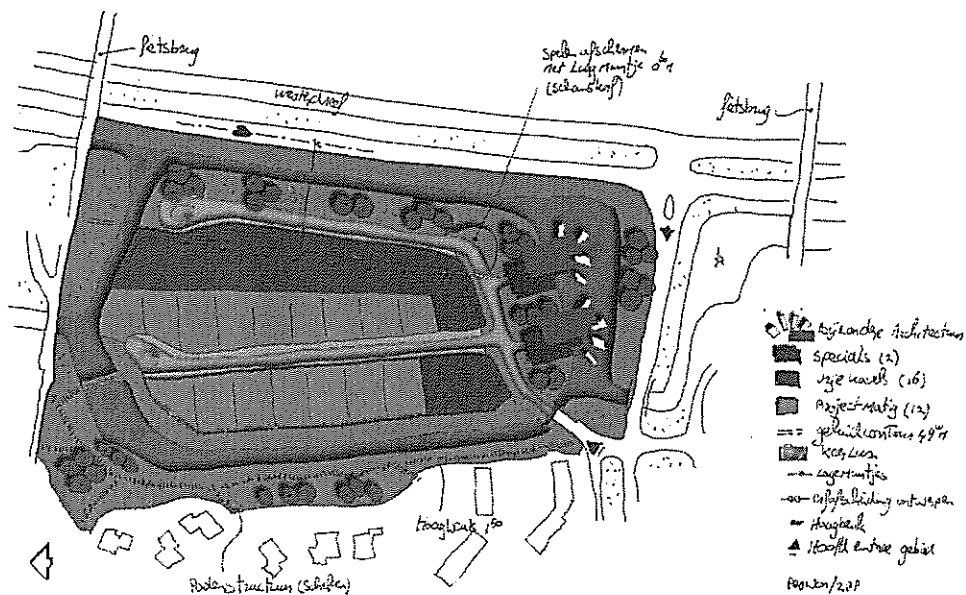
Stedebouwkundige schets uit de Nota van Uitgangspunten.
